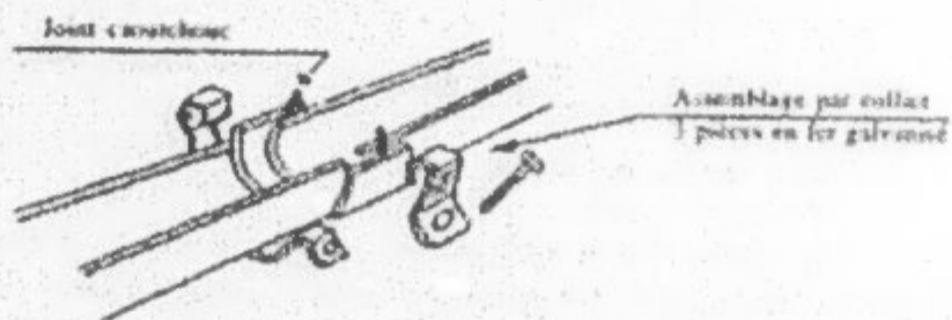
Schémas d'assemblage des coneux préfabriqués en amiante ciment
